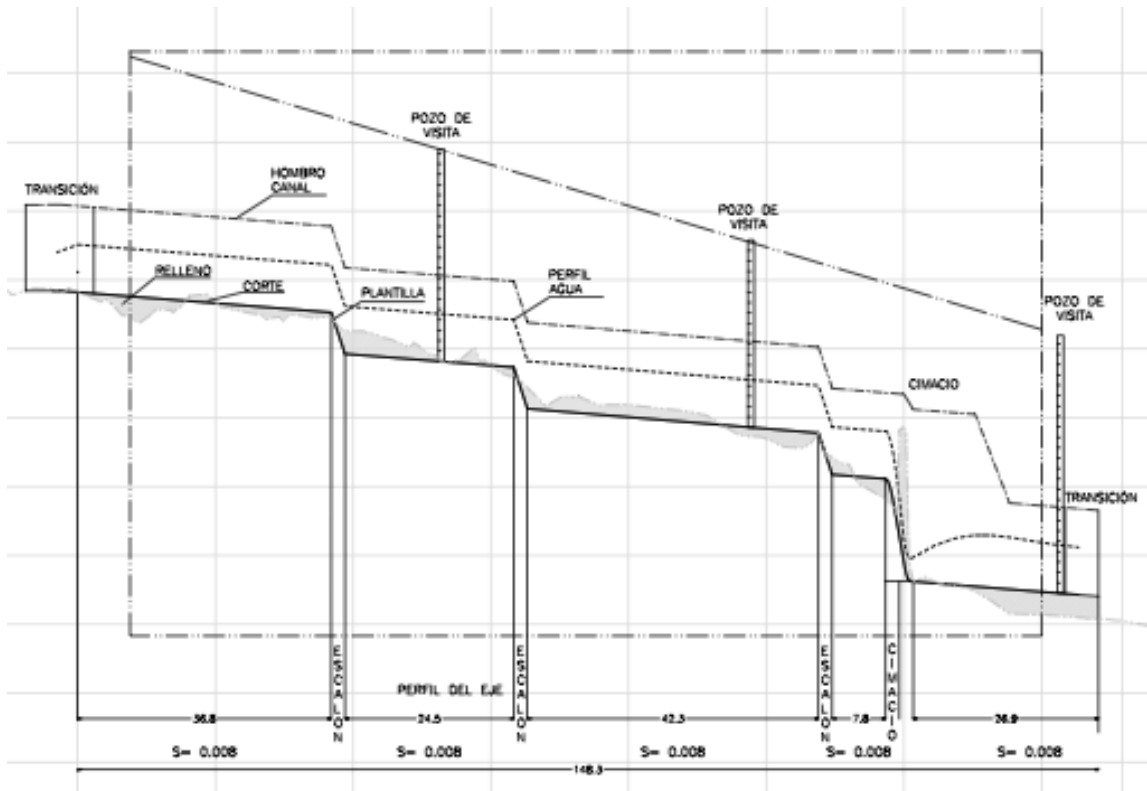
PERFIL DEL ENCAUZAMIENTO
